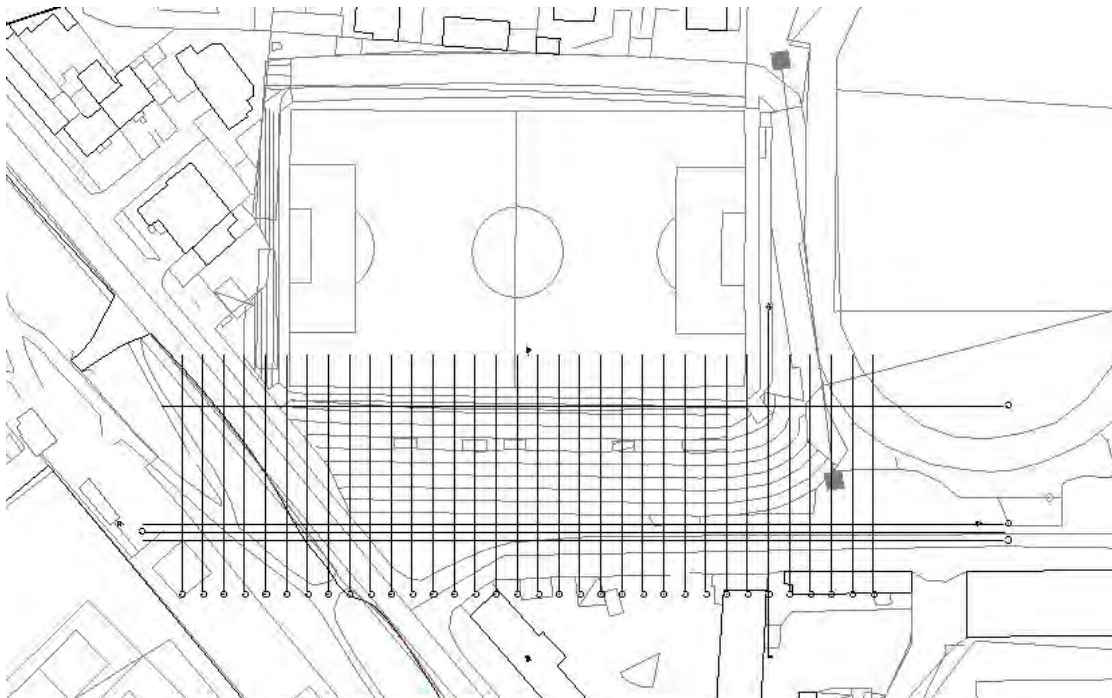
Planimetria del contesto e griglie di riferimento.
